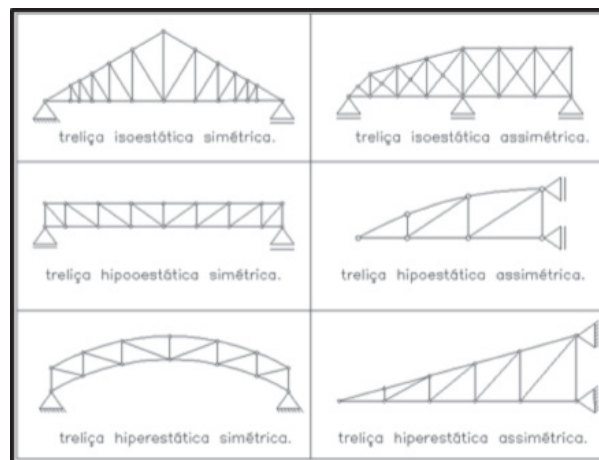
Ilustração dos tipos de estruturas compostas por elementos unidimensionais e sua classificação segundo sua montagem de barras
